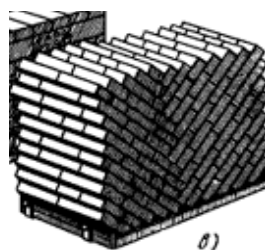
Укладка на поддонах кирпича с перевязкой в - "в елку"
